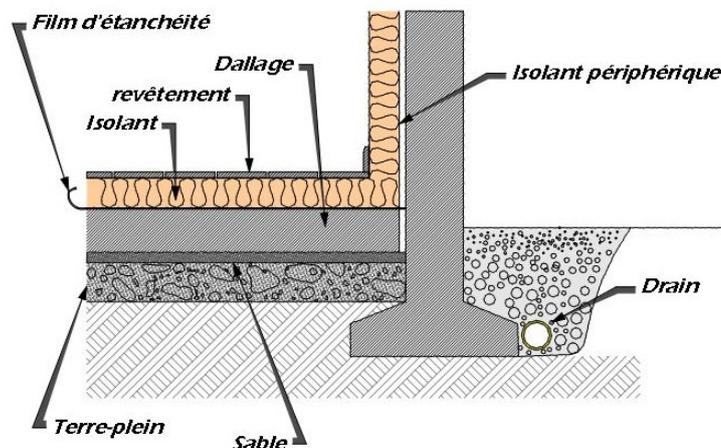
Isolation d'un plancher sur terre-plein (au dessus du dallage)
